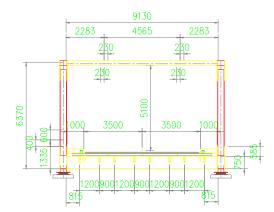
Dimensi Lantai Rangka Baja Perencanaan Jembatan Sei Rakyat
